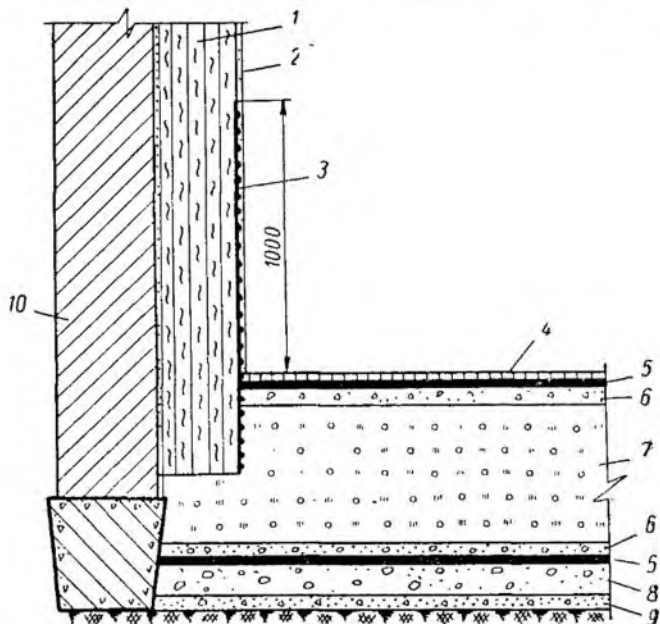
Изоляционная конструкция пола холодильника, расположенного на грунте:
